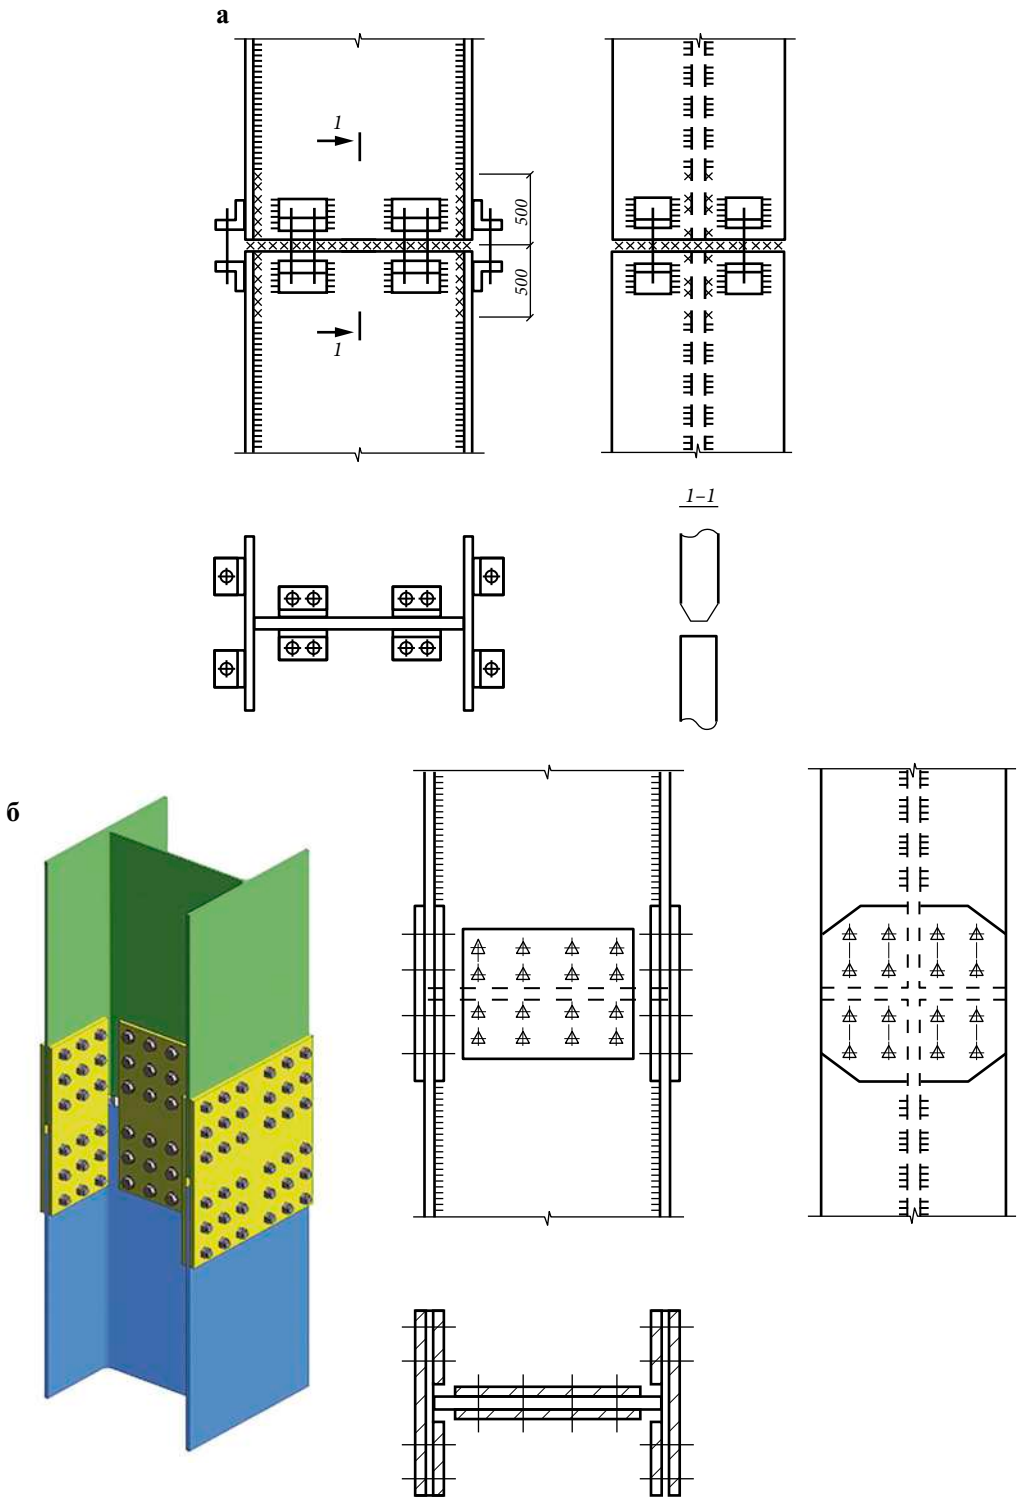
Монтажные стыки колонн: а) сварной; б) на высокопрочных болтах
